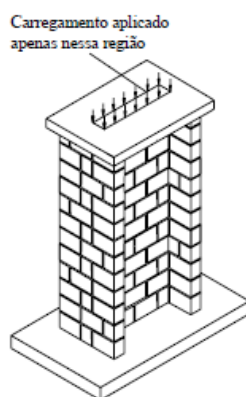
Painel H com laje. Capuzzo Neto (2005)
